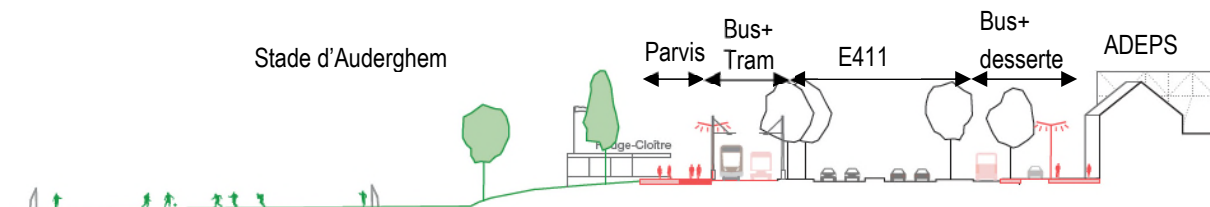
Profil du site Stade – Adeps (ORG², 2018)
